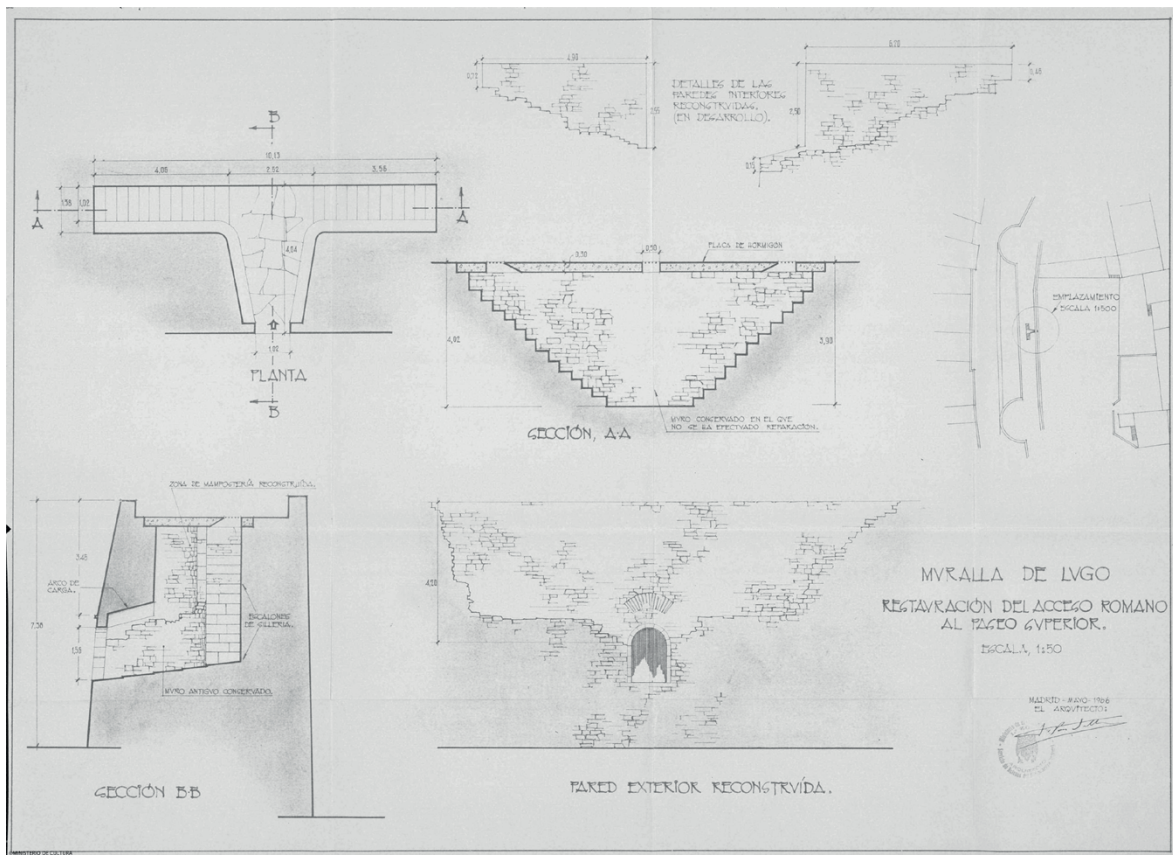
Plano de detalle de las escaleras restauradas por F. Pons Sorolla. Fuente: Murallas de Lugo (Lugo) - Restauración del Acceso Romano al Paseo Superior (1966).
